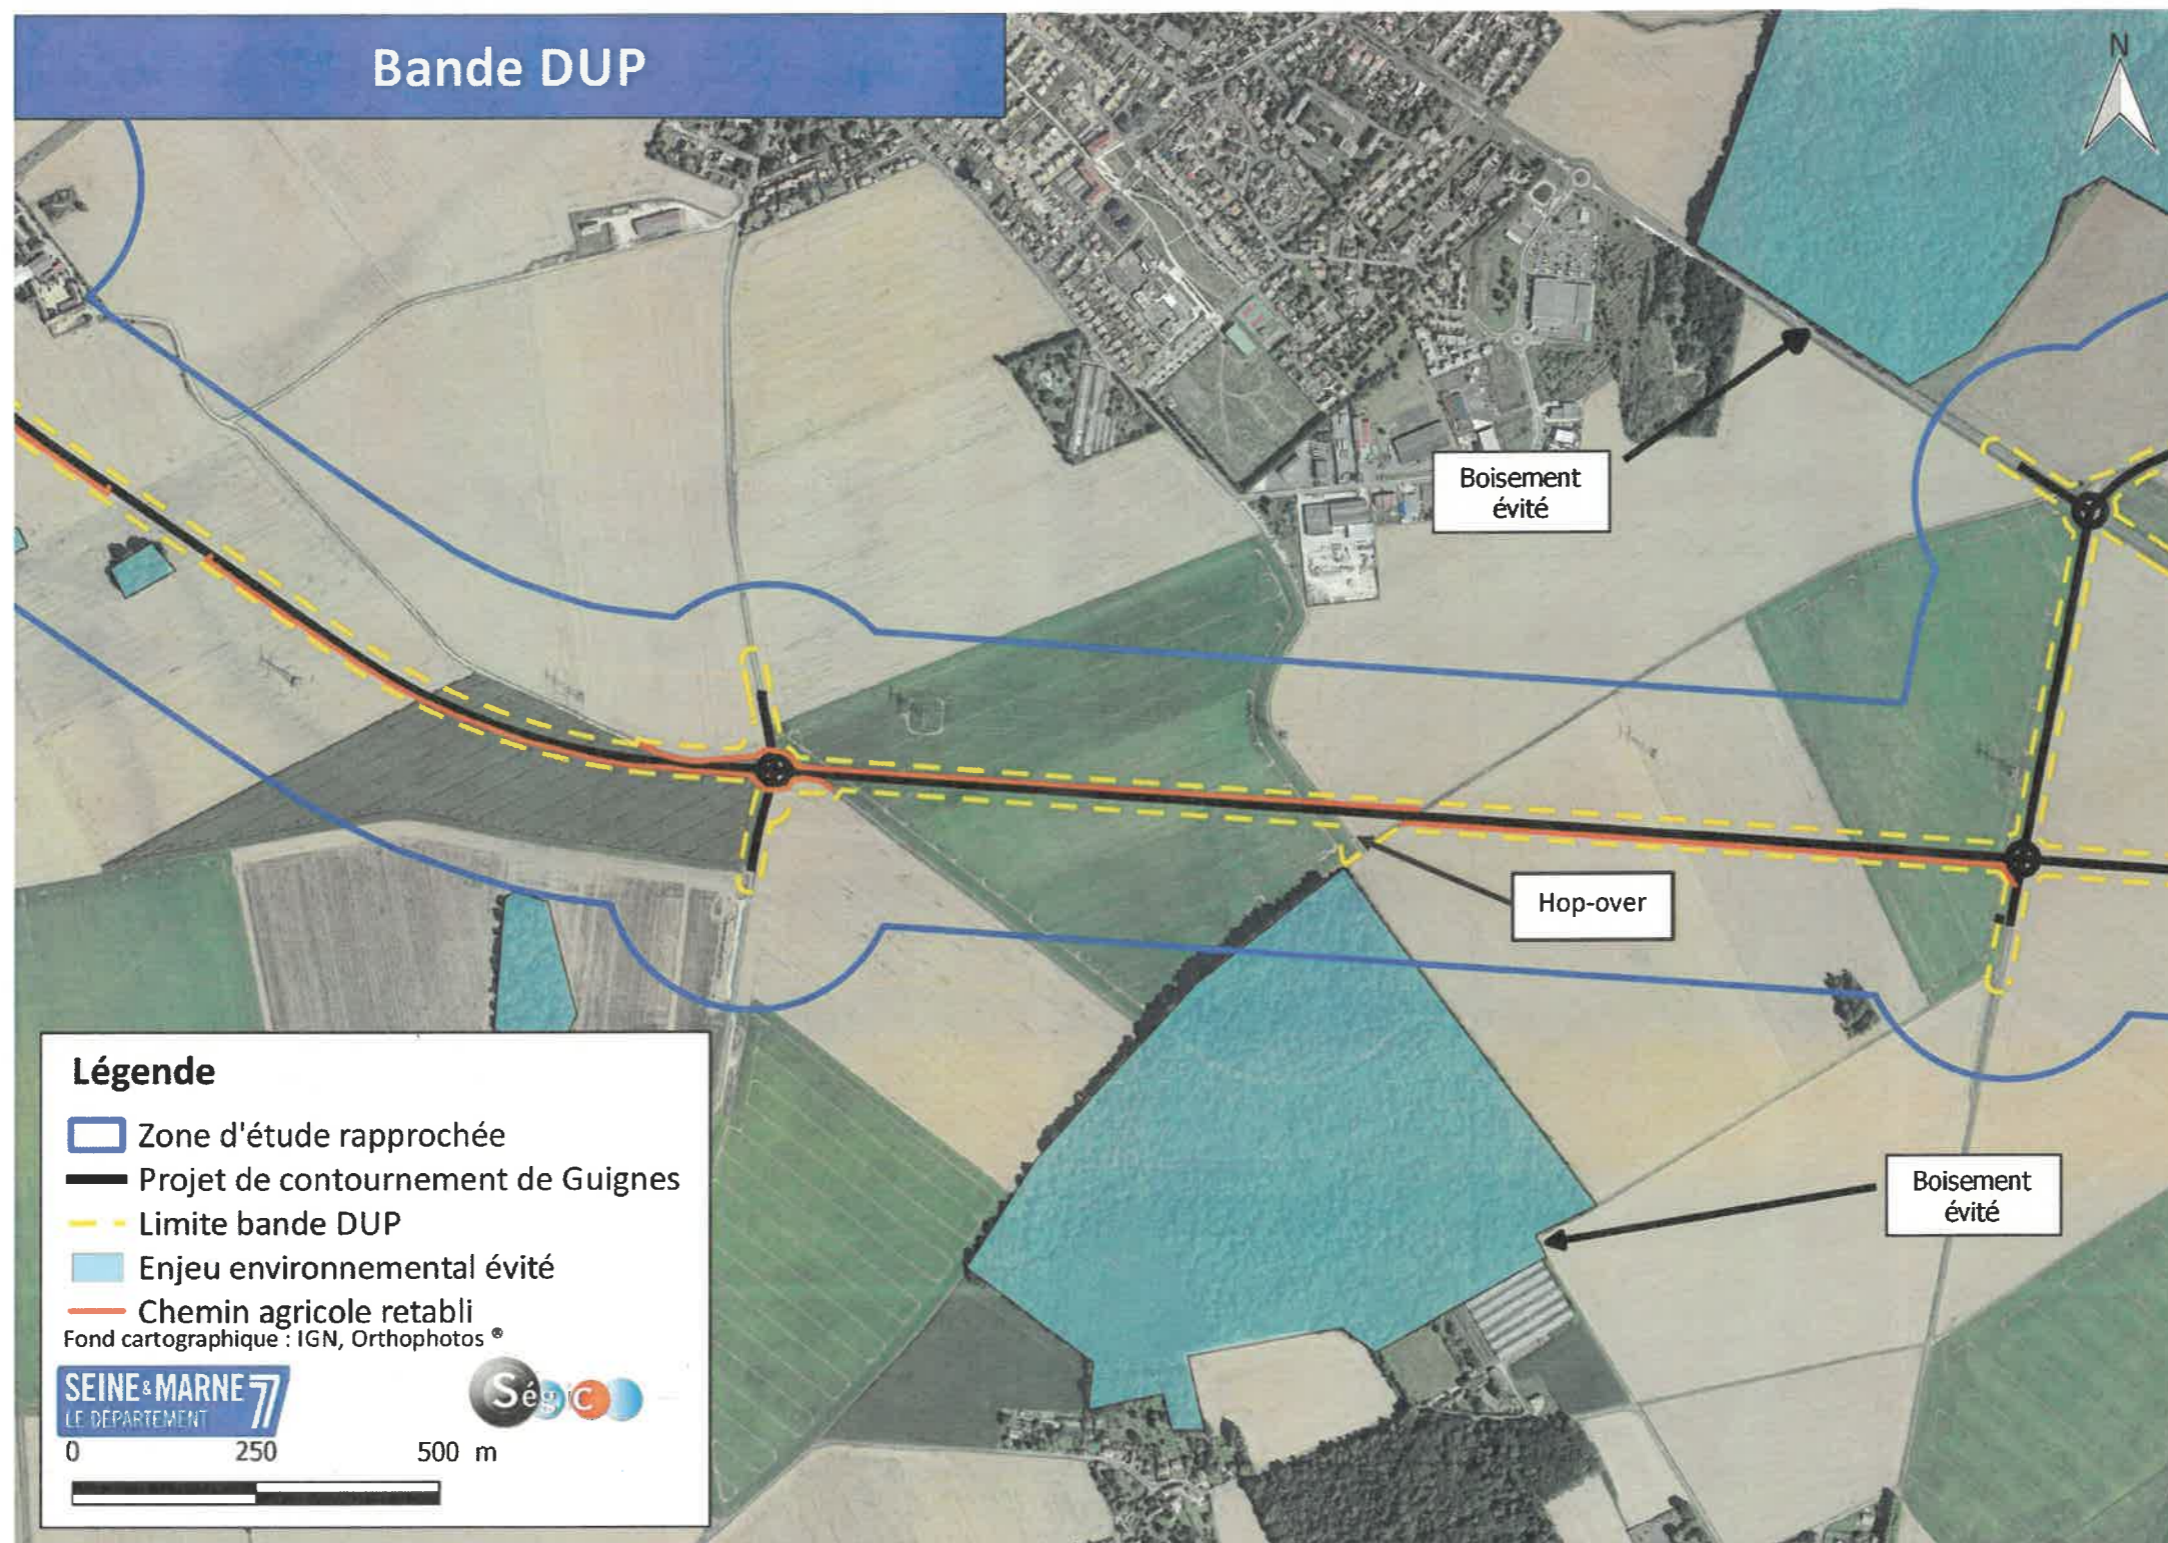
Bande DUP retenue – Planche 3/4 (Source : SEGIC Ingénierie)
